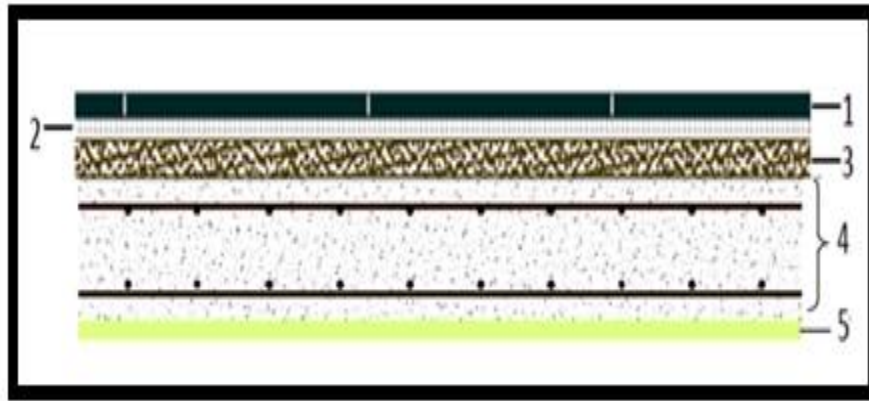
Composants d'un plancher étage courant dalle pleine.
